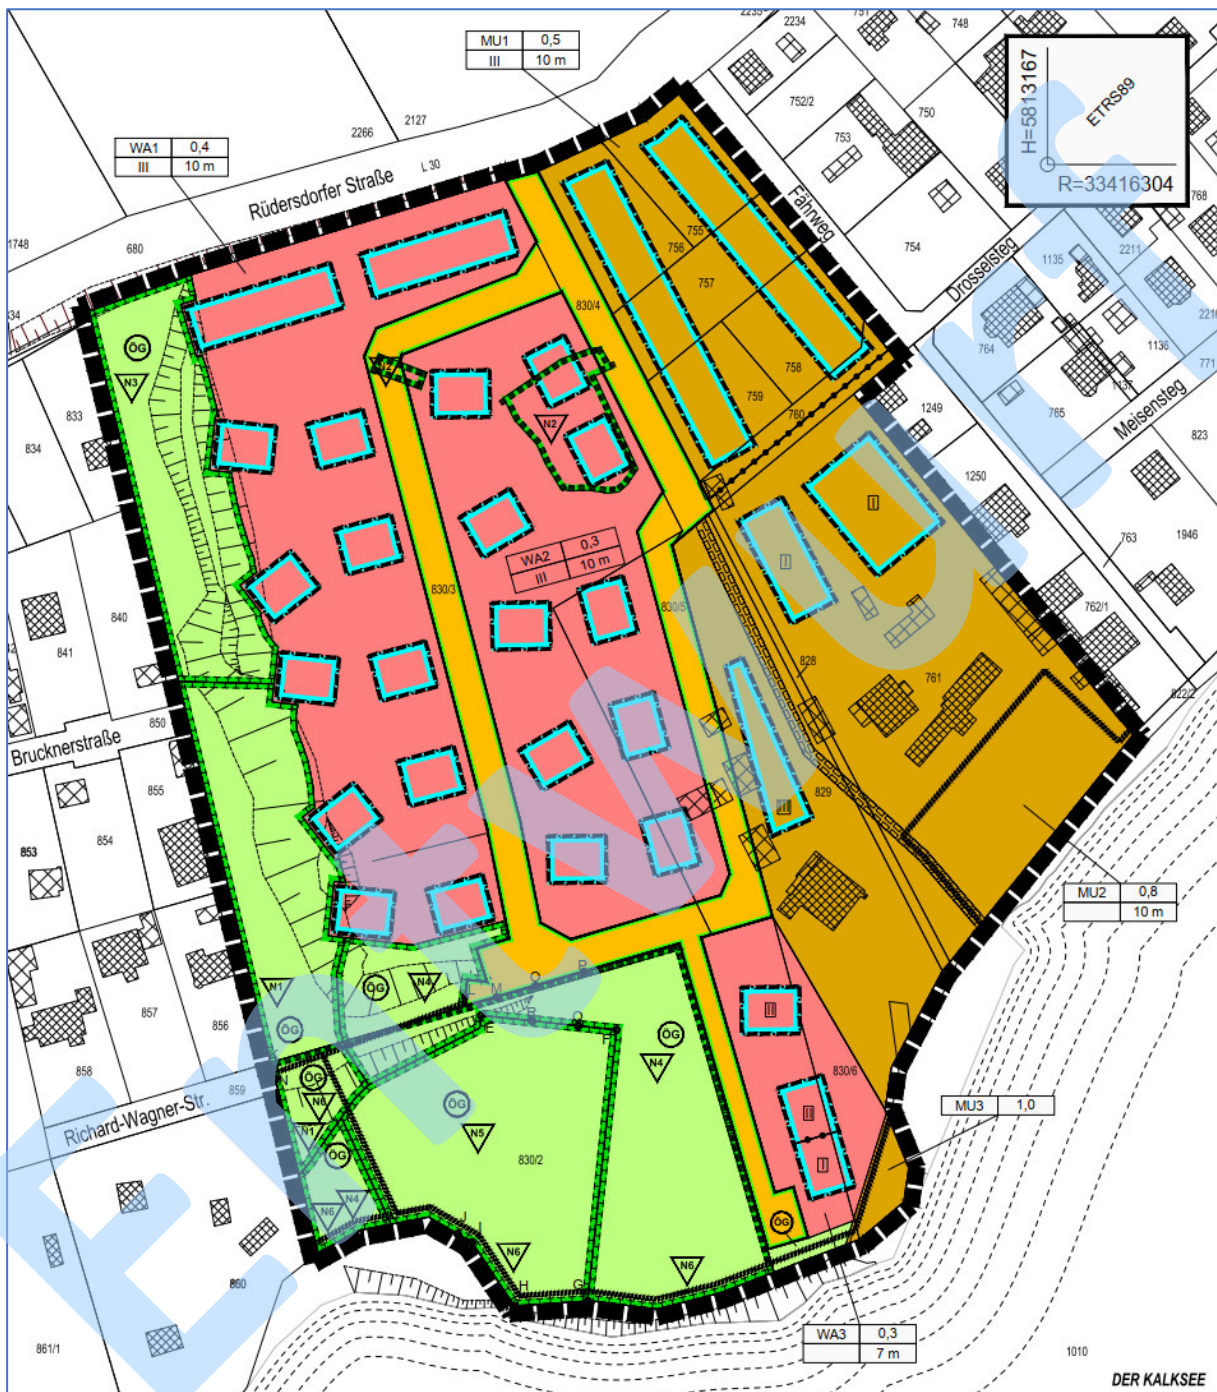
Planzeichnung des Bebauungsplans „Rüdersdorfer Straße 44 - 46“ [A]
